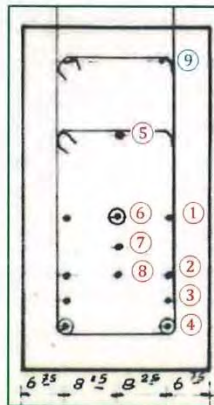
Plan de ferrailage des poutres - Coupe transversale
